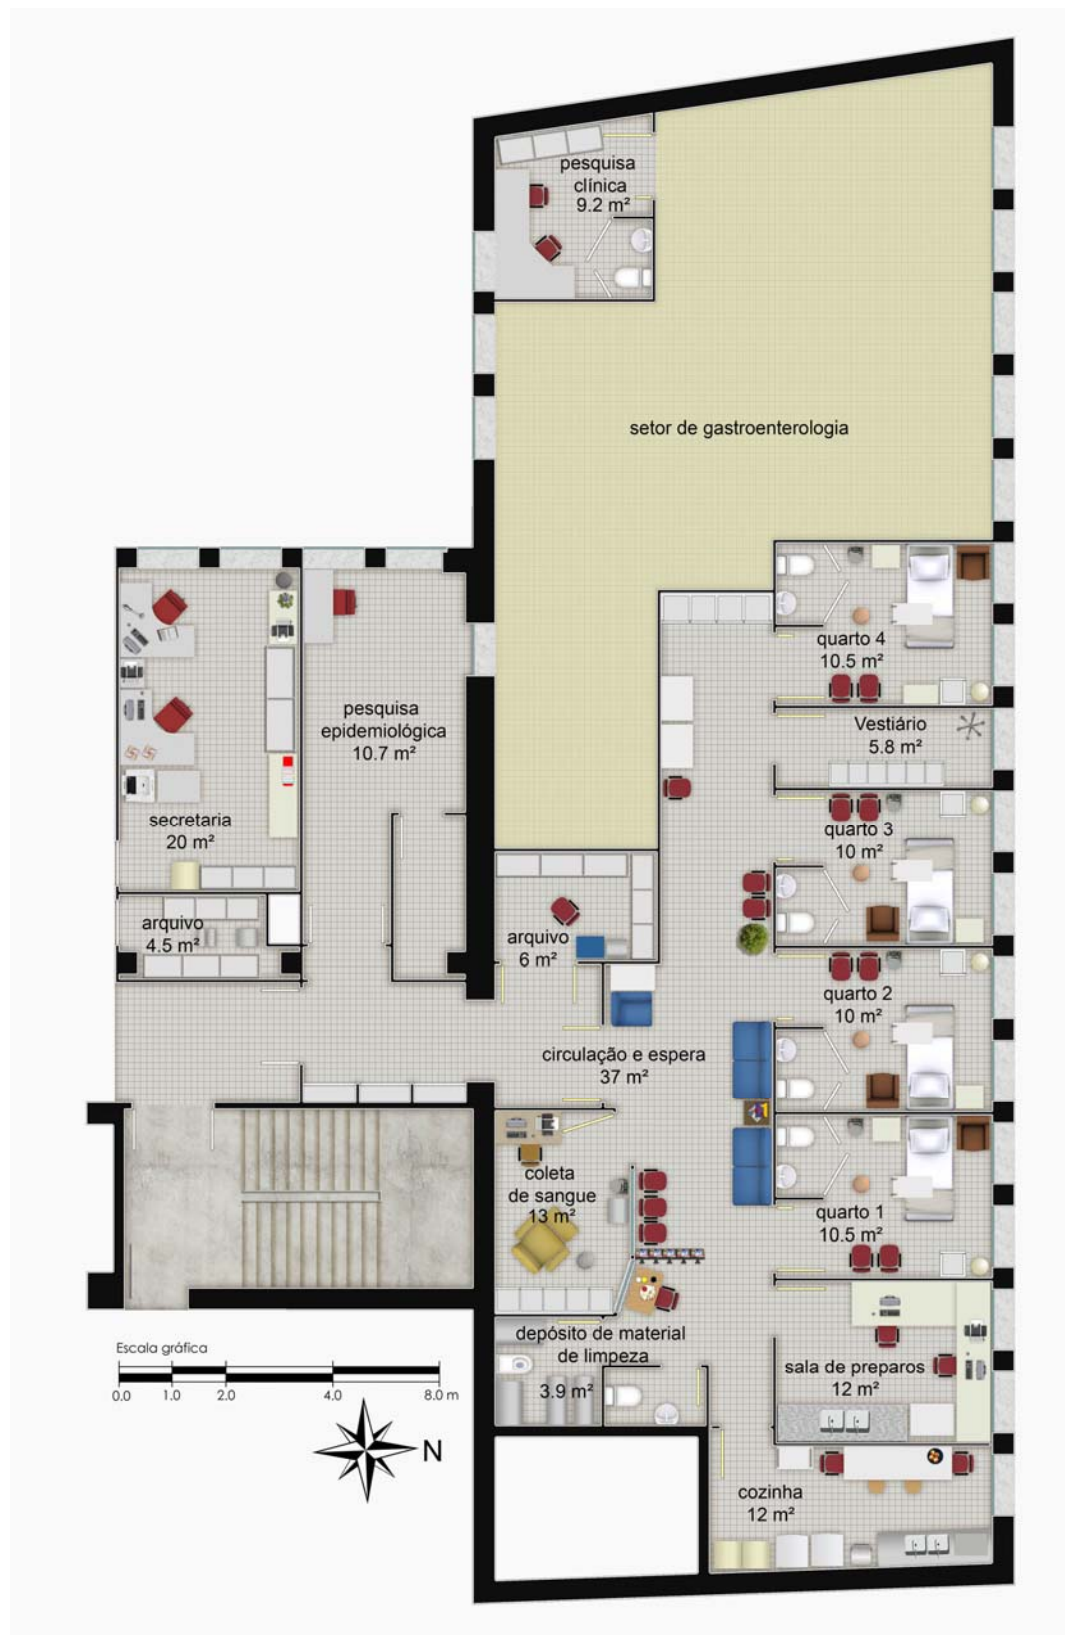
Planta do hospital-dia VIH anterior ao projeto – 1º pavimento<sup>35</sup>
